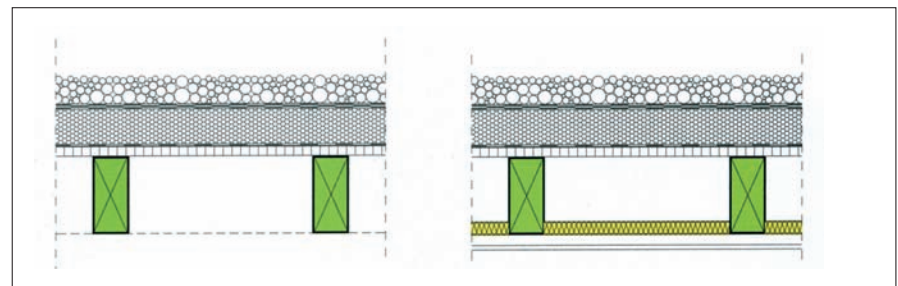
Flachdach mit dreiseitig sichtbarem Deckenbalken
